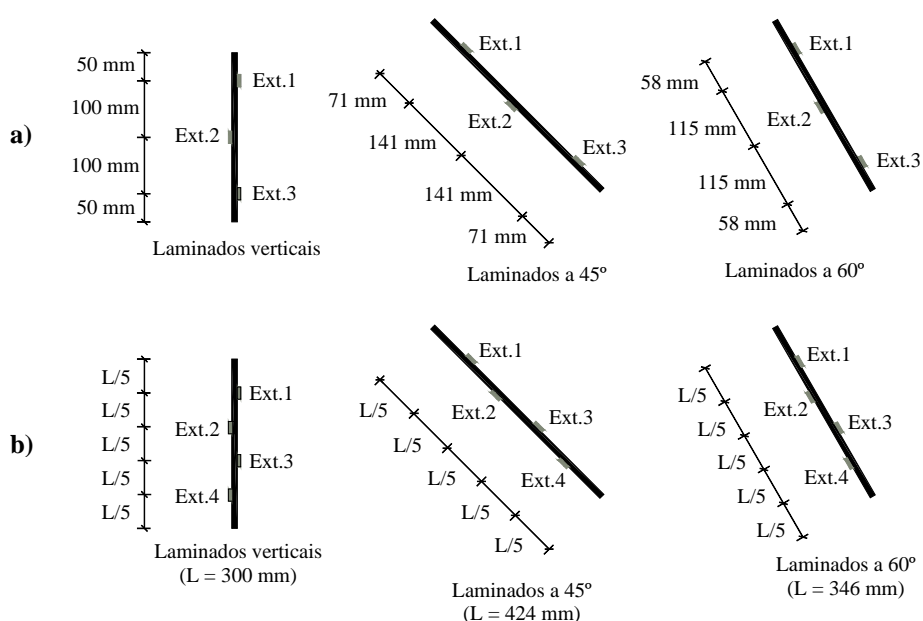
Disposição dos extensómetros aplicados: a) CFRP A e C (Ext.1, Ext.2 e Ext.3) e b) CFRP B (Ext.1, Ext.2, Ext.3 e Ext.4).
